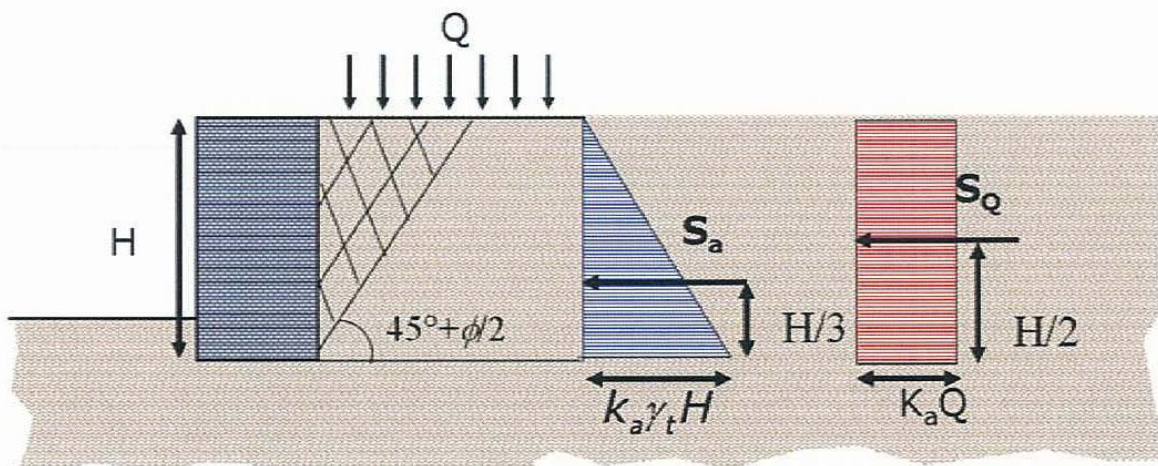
Diagramma della spinta attiva di un terreno non coesivo sottoposto a un sovraccarico uniformemente distribuito.
